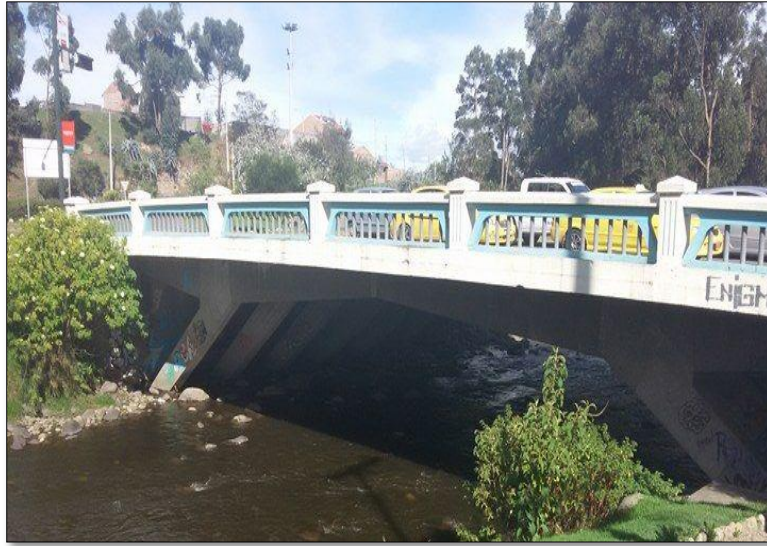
Puente de hormigón armado avenida 12 de abril, Cuenca. Elaborado por: Autor
